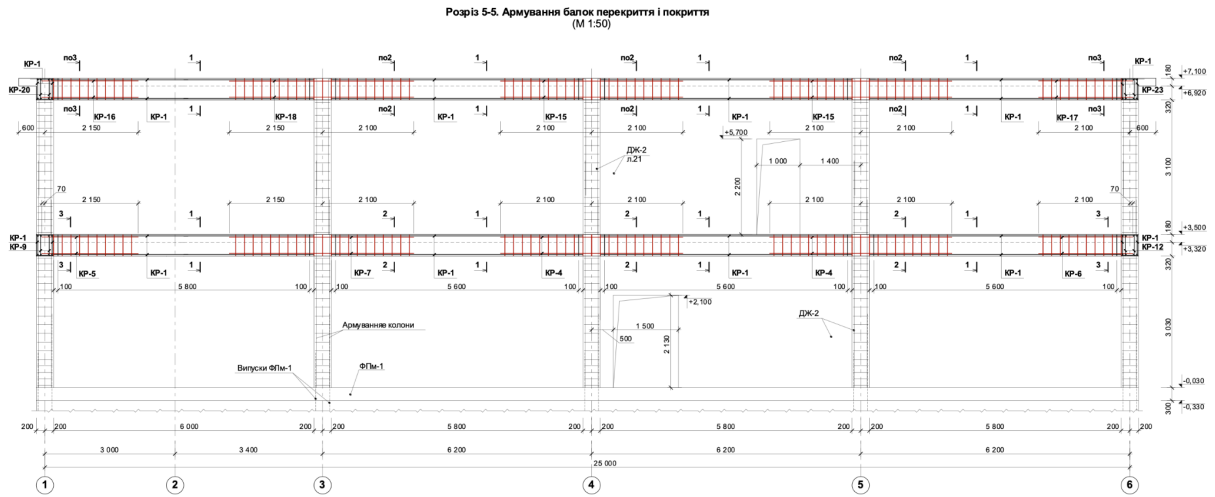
Армування балок перекриття і покриття (розріз 5-5)
